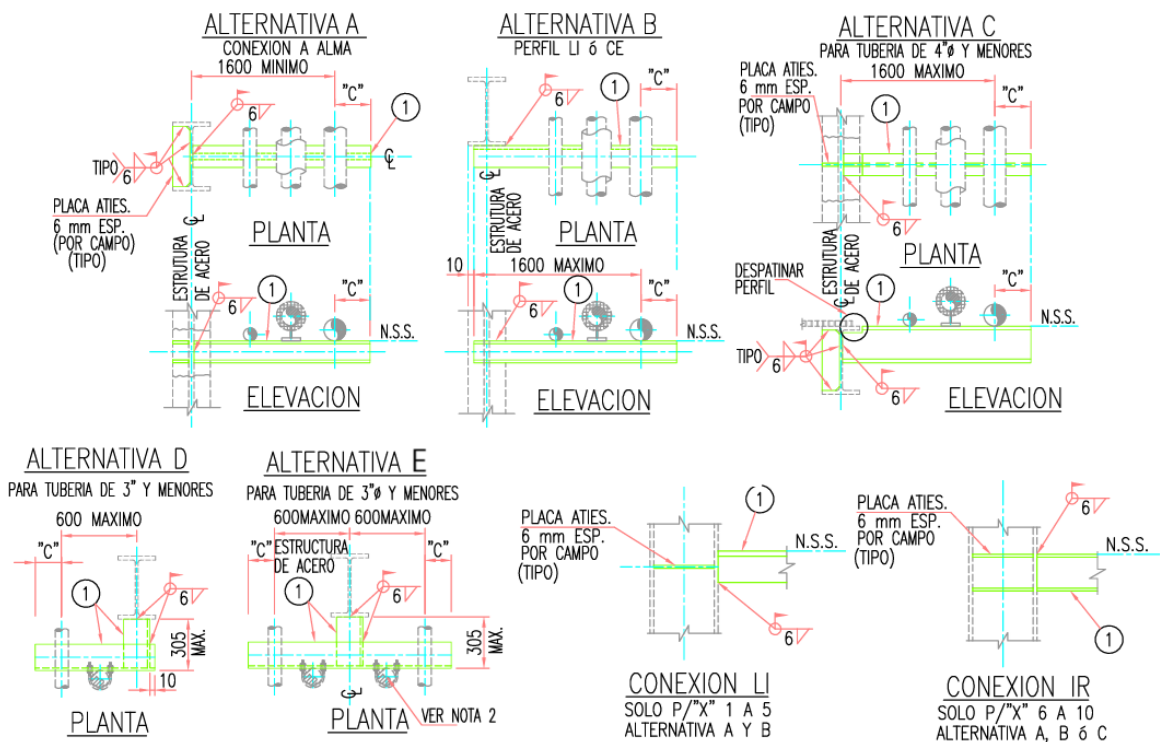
Detalle de soporterías de tuberías según E.T del proyecto
